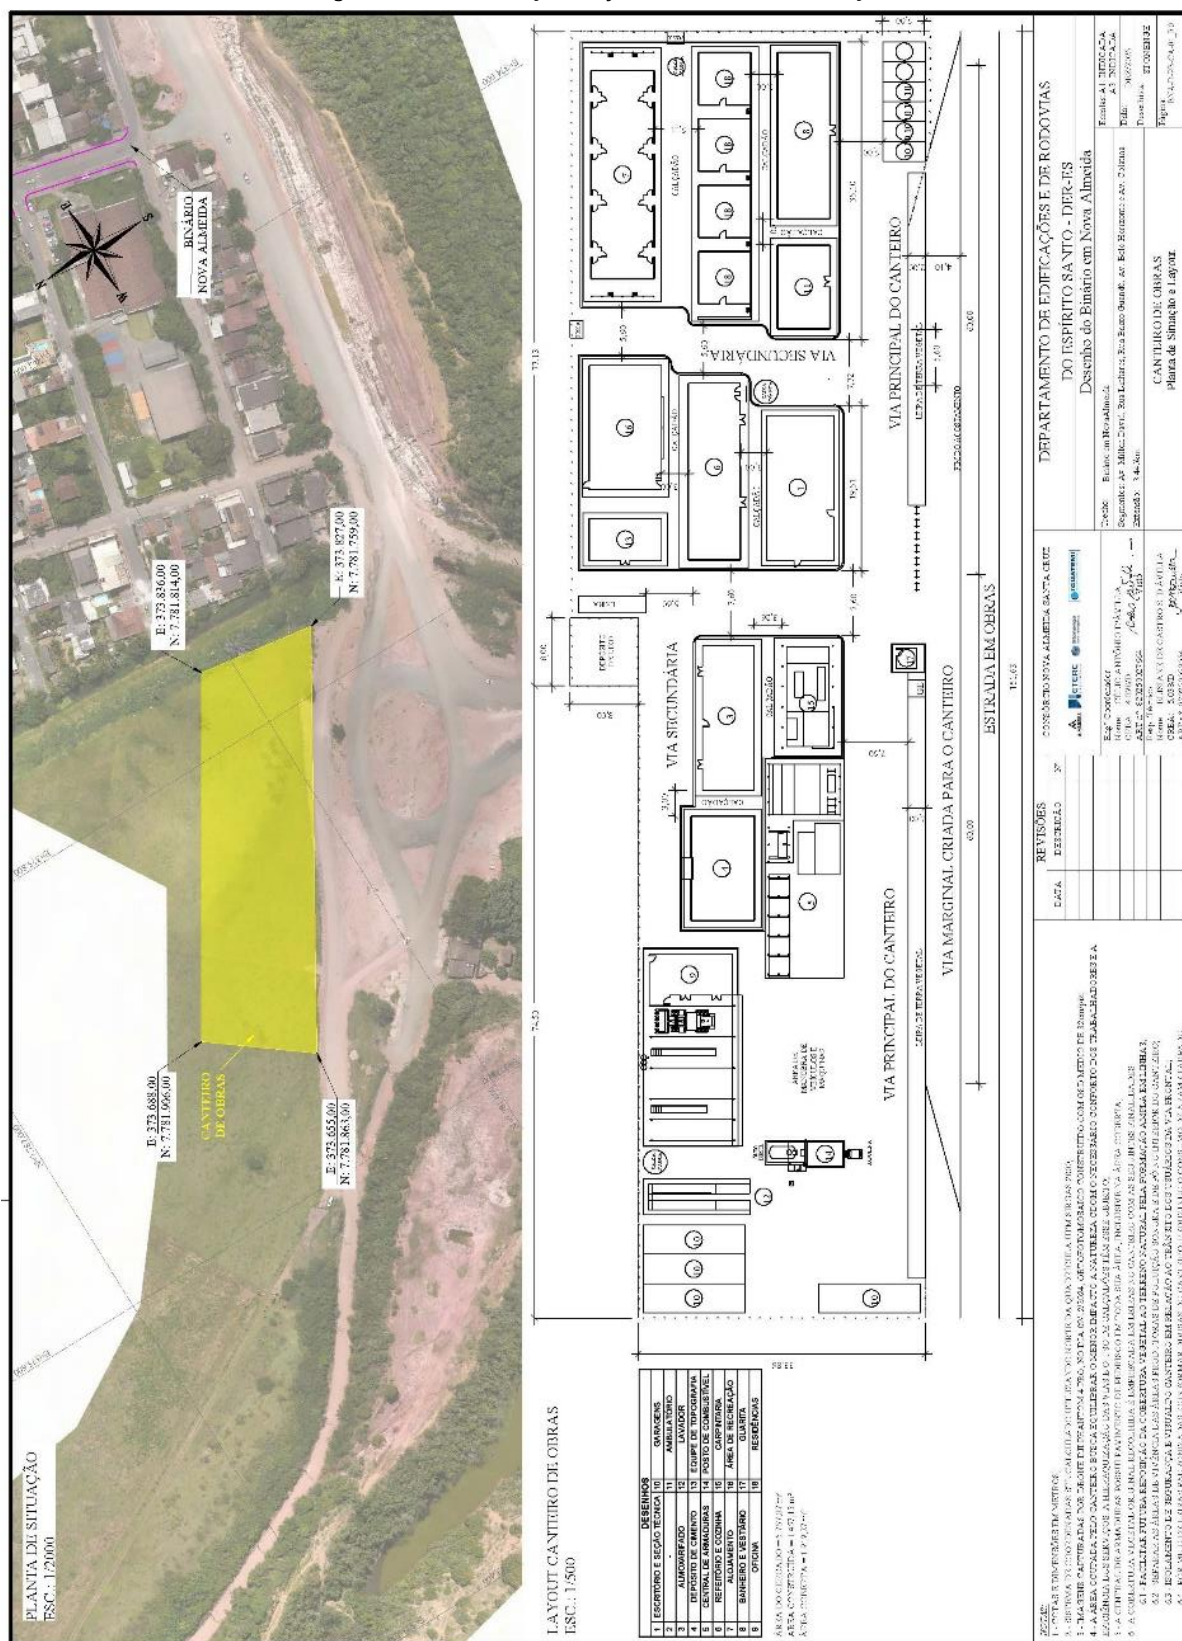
Vista geral da proposta para o canteiro de obras
